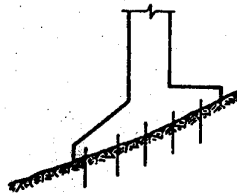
Anclaje para evitar desprendimientos de bloques (CFE, 1981).
